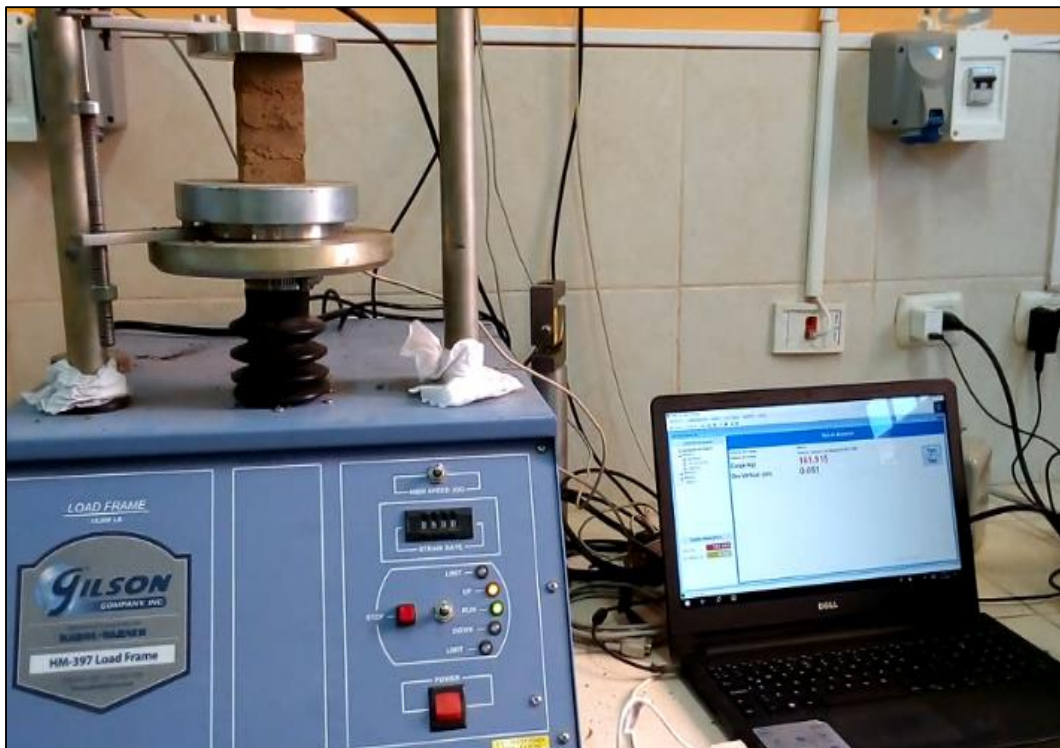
Display del software de la prensa hidráulica, aplicado en el ensayo de pila (Pila P4)
